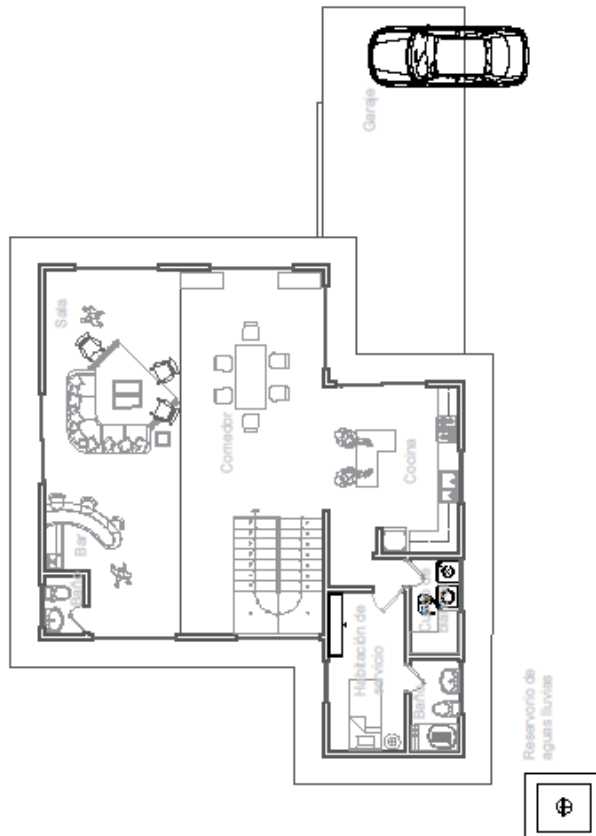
Planta baja - Vivienda Bioclimática Modular sector Nobol
